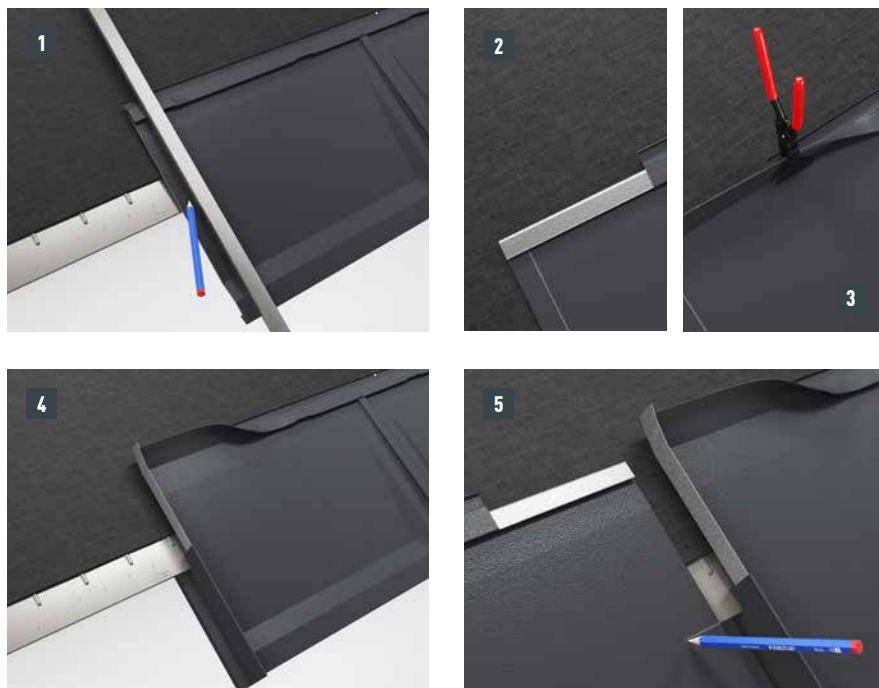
• Formowanie występu dachu – dachówka klasyczna
